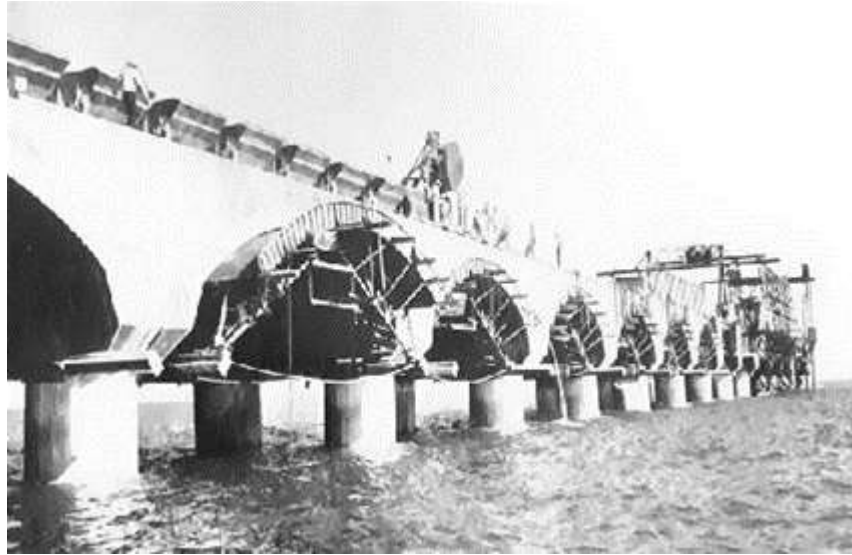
Vista del proceso constructivo de los arcos de concreto simple (Christensen, 1954)
